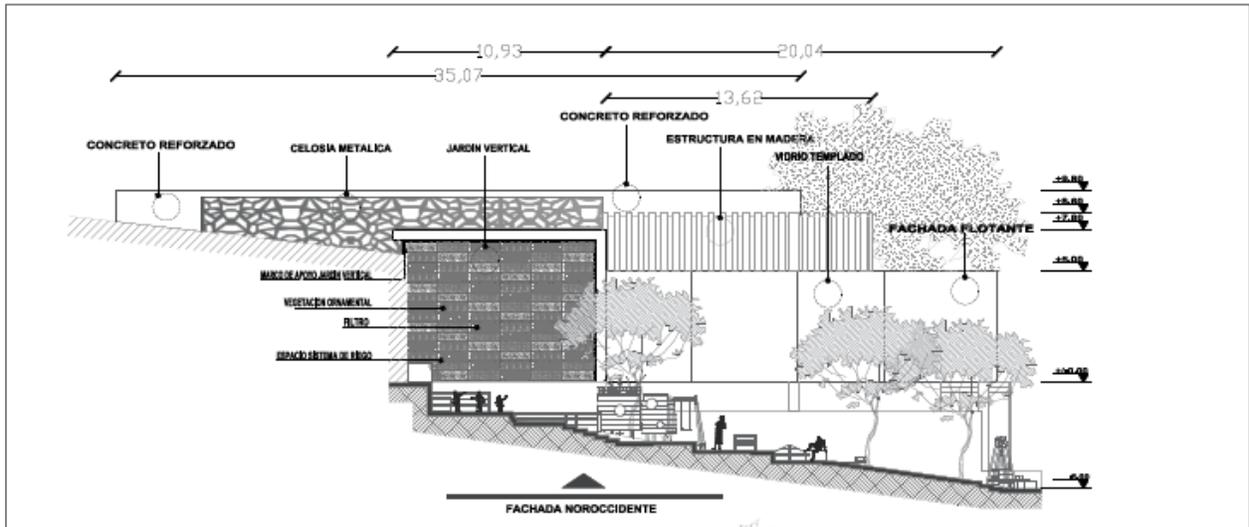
Fachada Noroccidente Edificio 1 (Rubiano, 2020)
